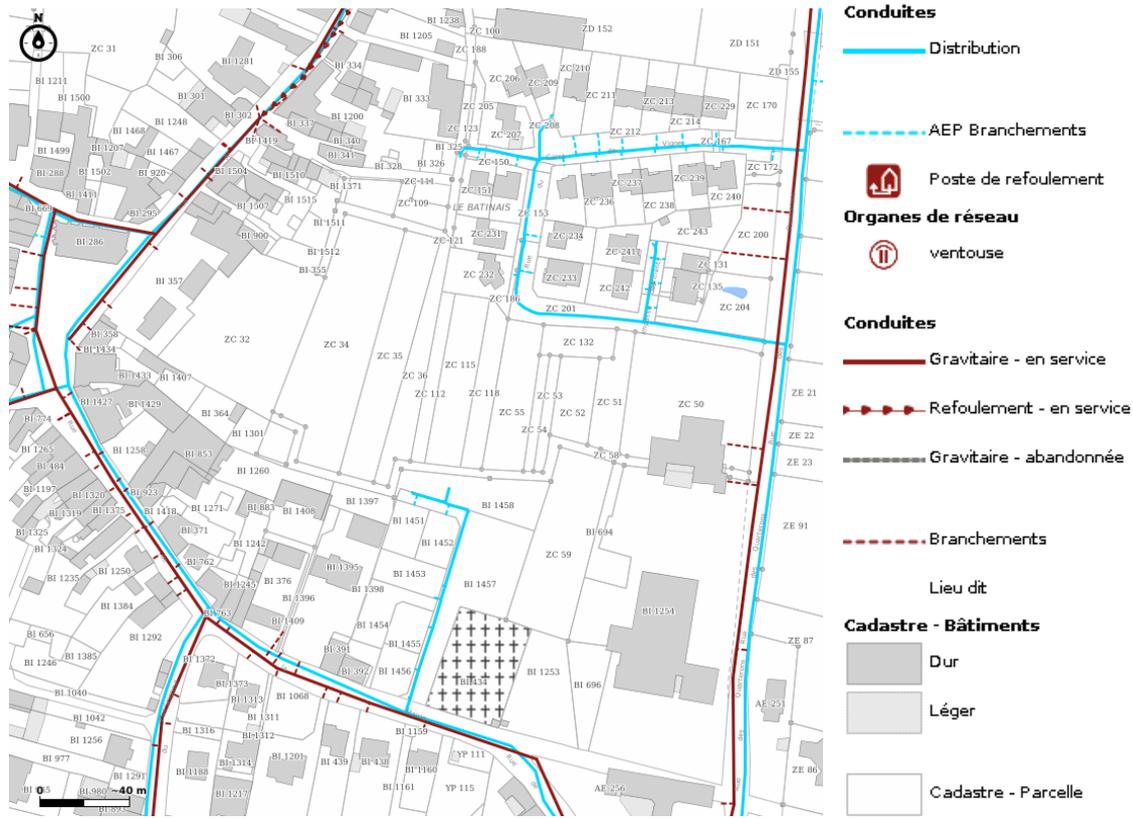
Carte des réseaux d'assainissement des eaux pluviales et usées
